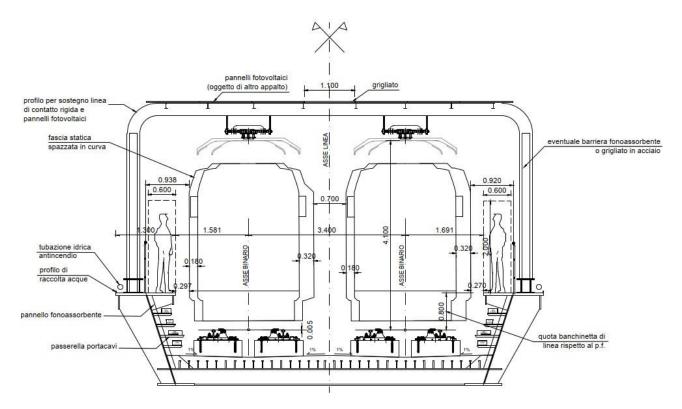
Sezione trasversale dei binari con plinti in calcestruzzo armato
